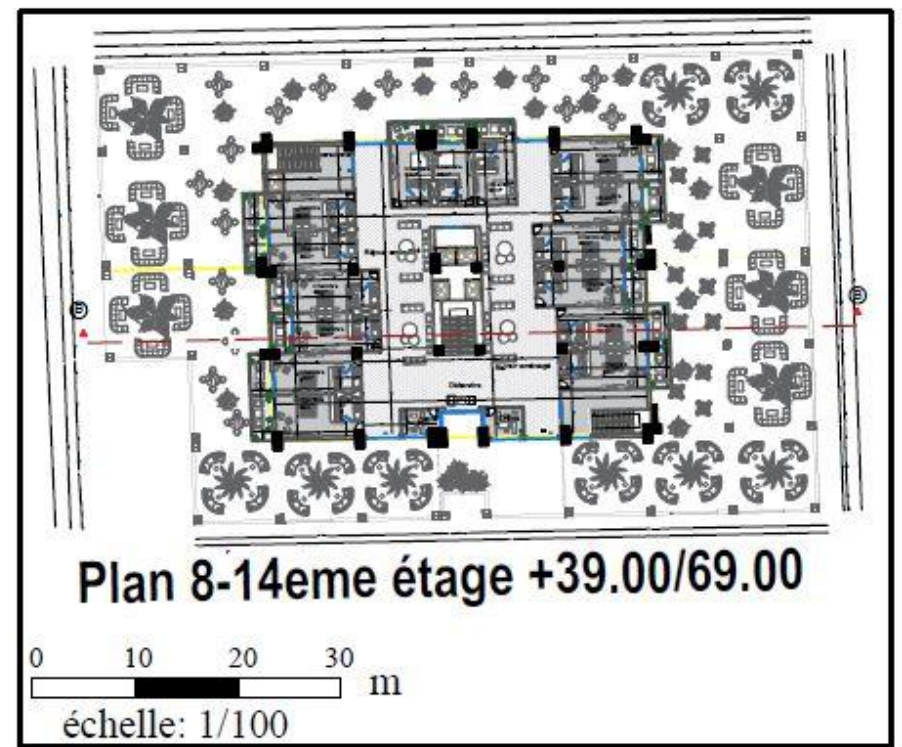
Plan de 8-14 Emme étages+39-69.00/Source : Traiter par l'auteur.
